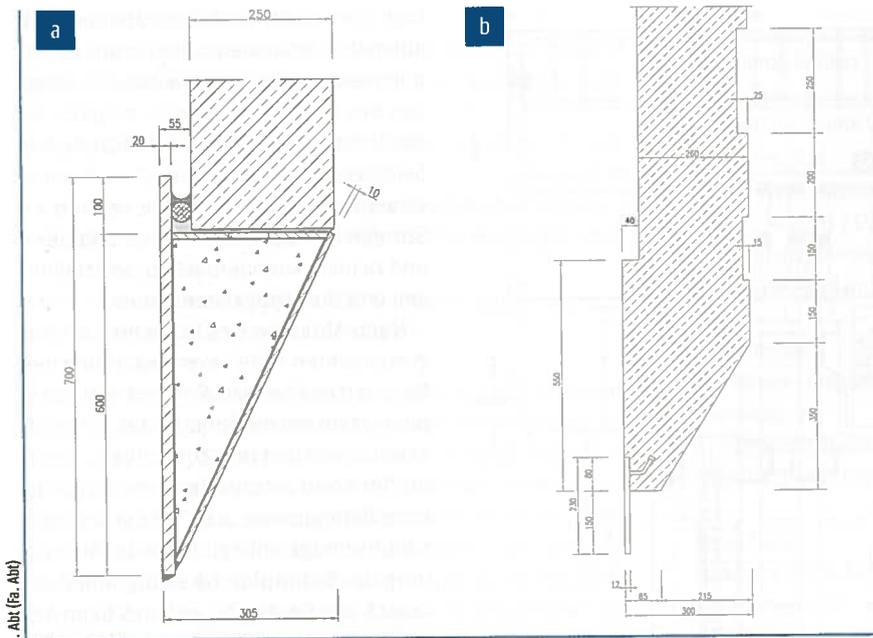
Technische Ausführungen von Schneidschuhen mit Überschnitt für Bentonit- und Betondämmverpressung (a) sowie den Aussparungen für die Anschlussbewehrung (b)
